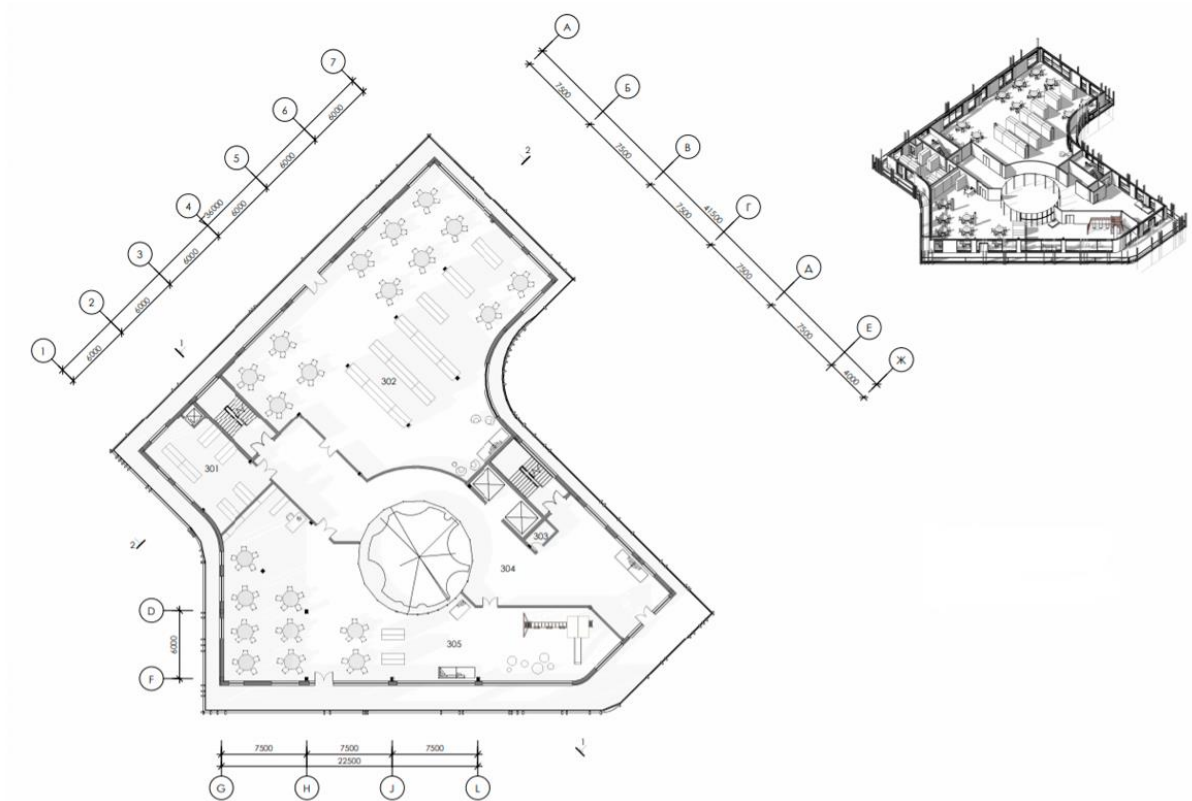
(схема плану поверху на відмітці +4.500)
